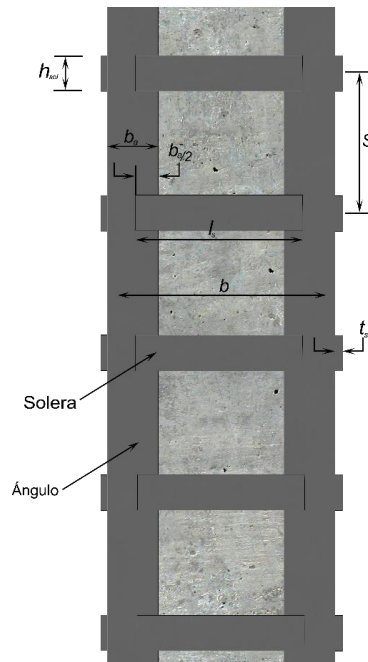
b - Columna encamisada con ángulos y soleras
